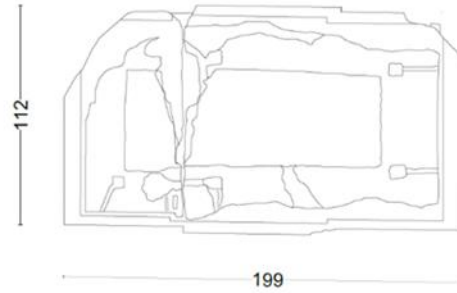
Batı Yan Ayak Ölçek: 1/20
